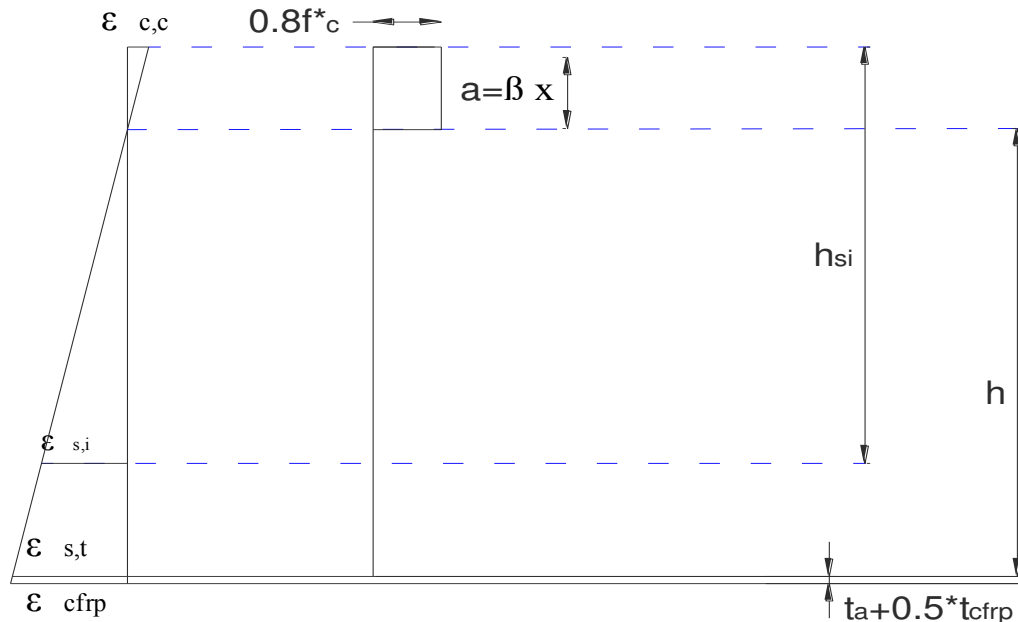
Esfuerzos y deformaciones de una sección compuesta, acero-concreto reforzada con cuando el eje neutro se encuentra en la losa de concreto.
